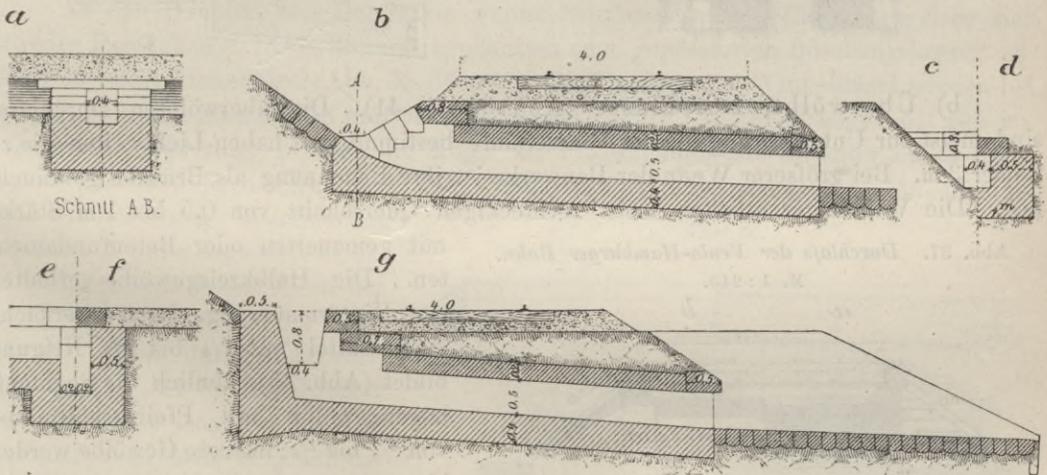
Plattendurchlässe der österreichischen Nordwestbahn. M. 1:100.
